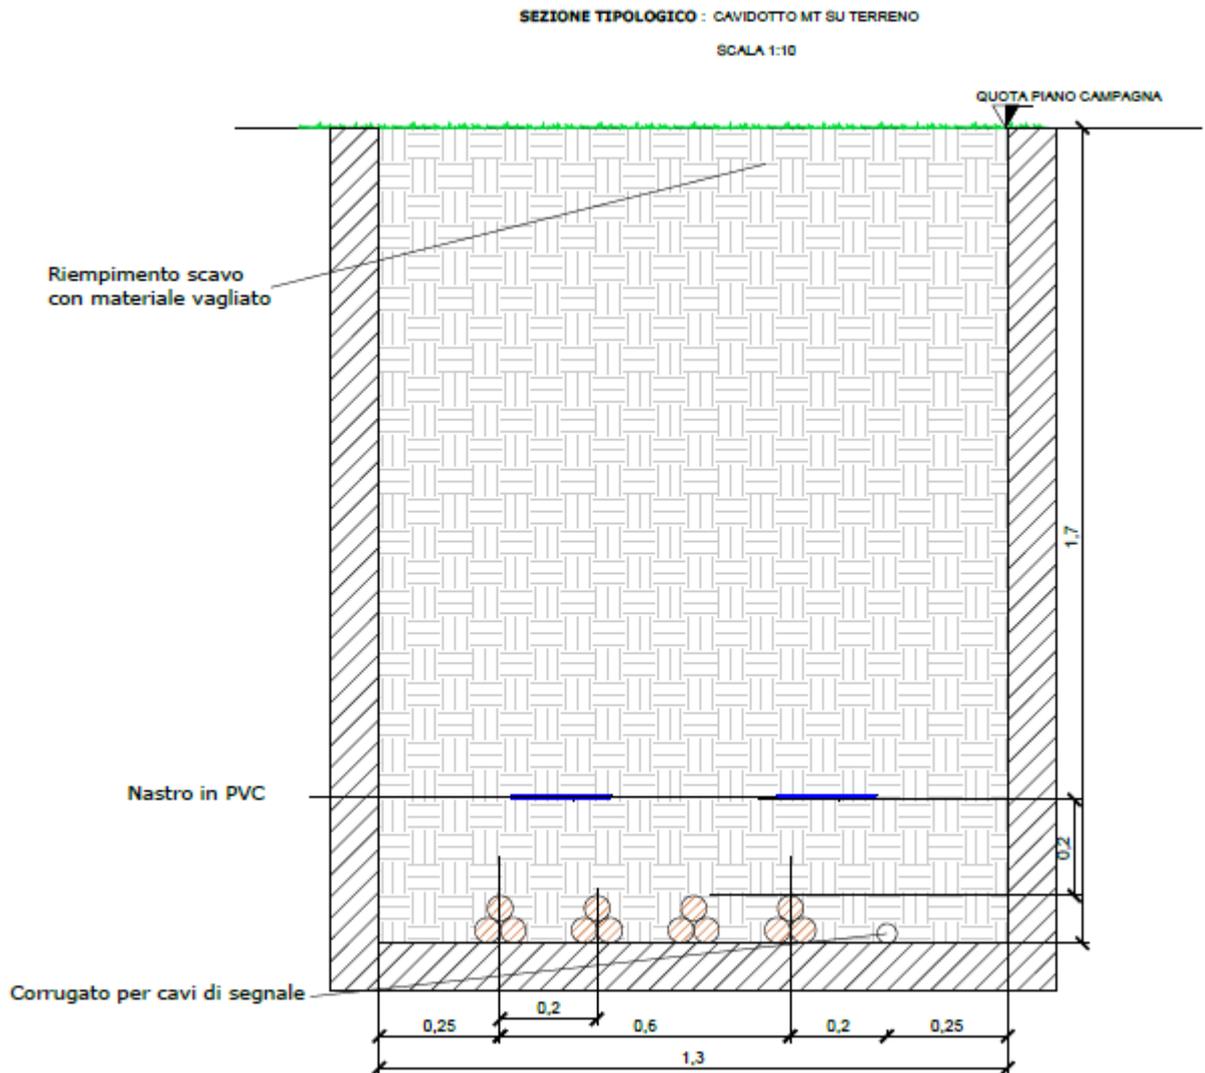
Sezione tipo posa con cavi direttamente interrati lungo terreno
